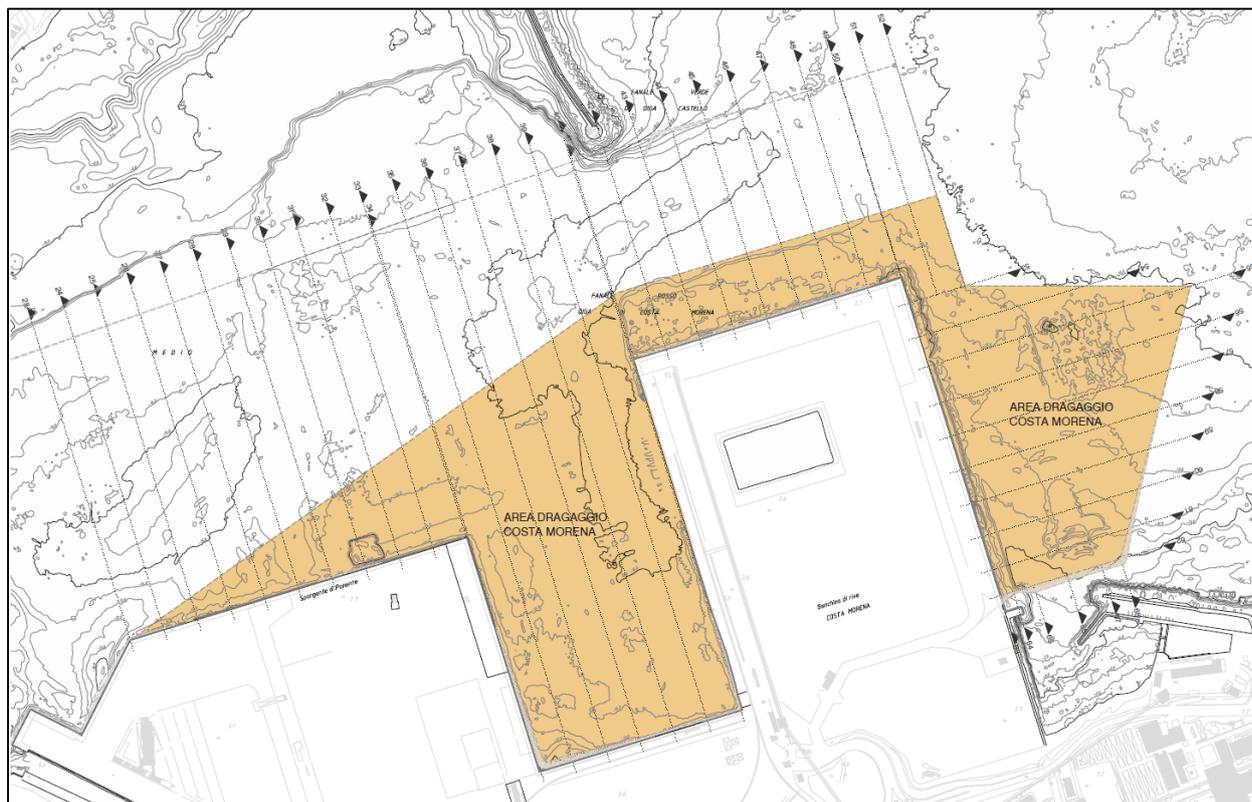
Planimetria di dragaggio Area Costa Morena
